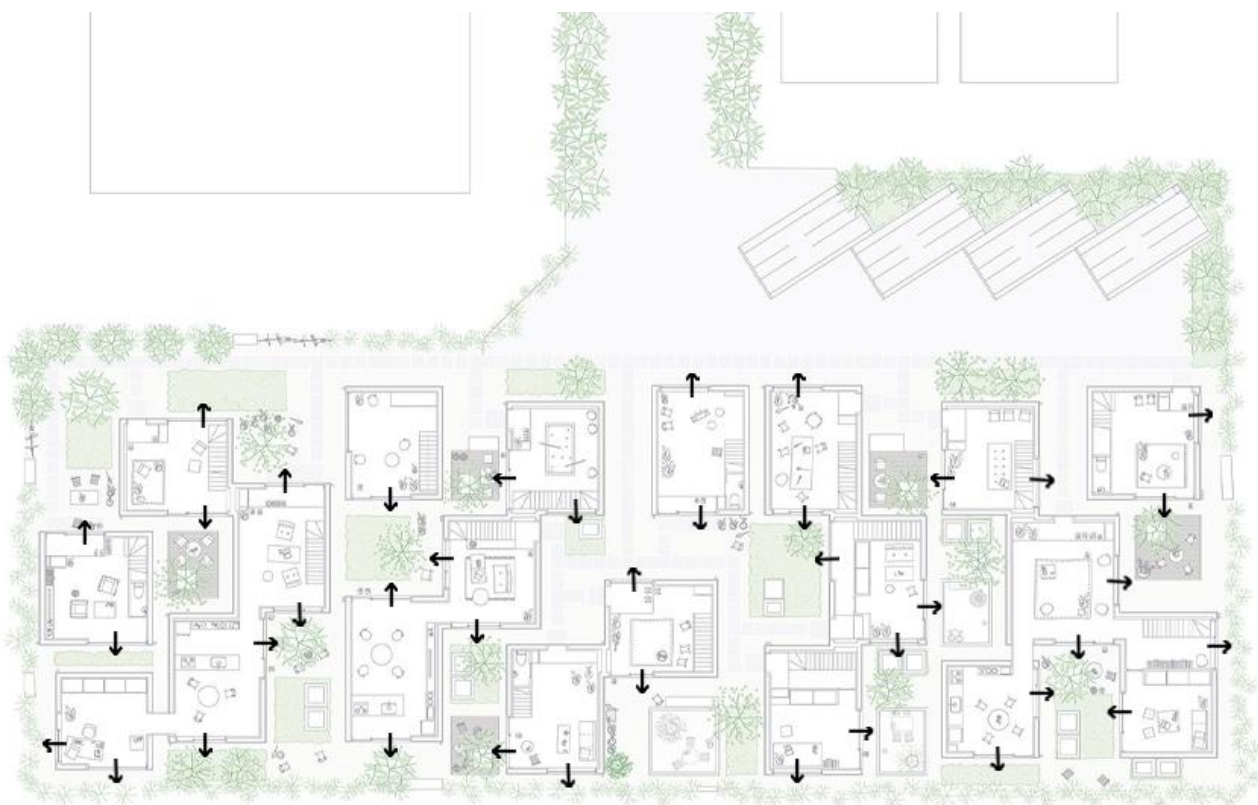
Schéma des ouvertures du projet Seijo Town Houses
